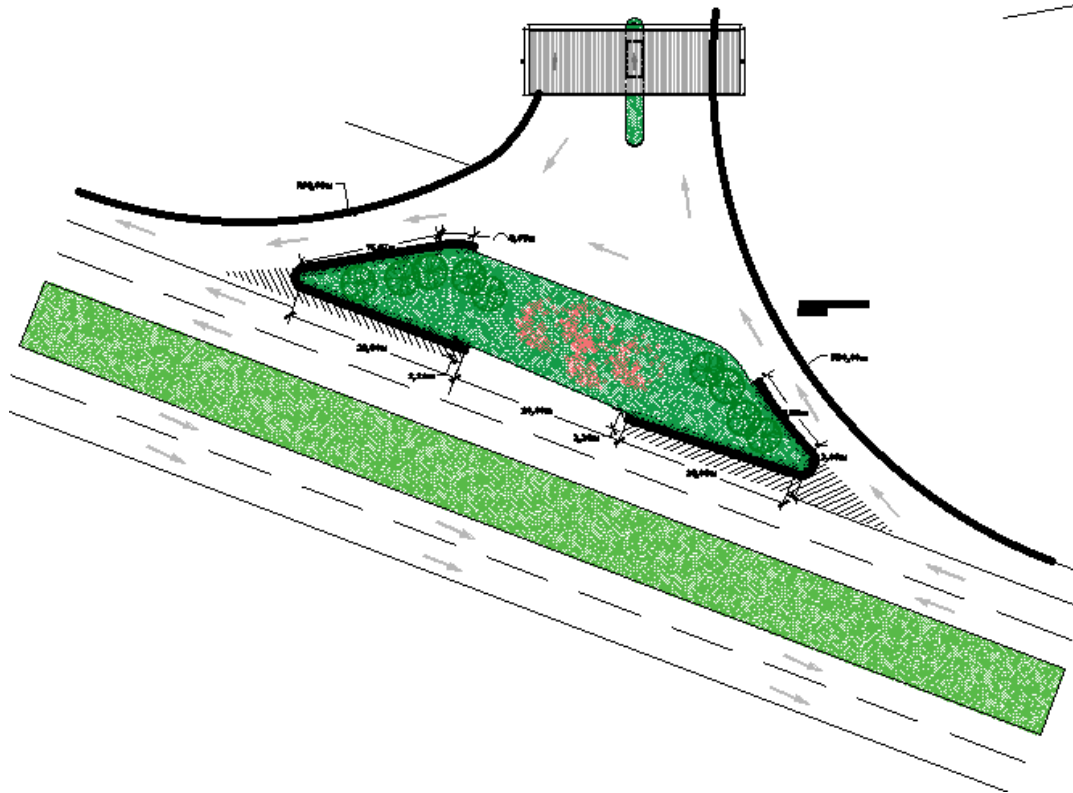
Acceso desde RN 14. Fuente: Elaboración propia
